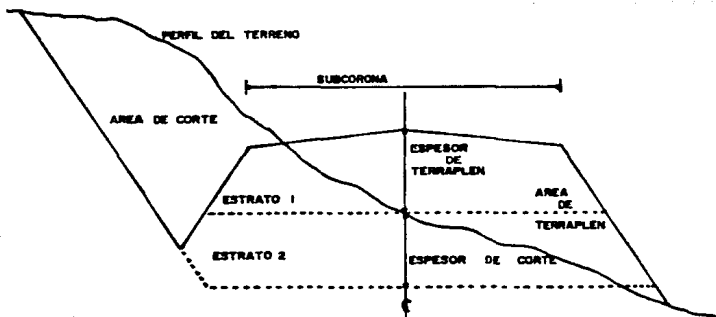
SECCION TRANSVERSAL EN BALCON.
